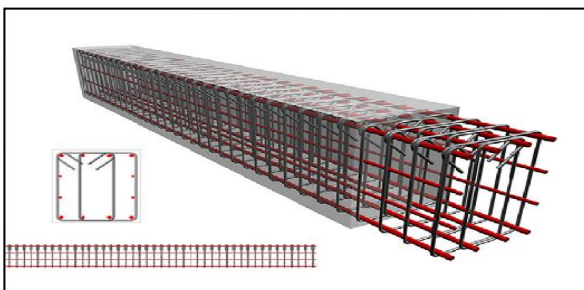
Vigas de concreto armado y perfilería de acero, fuente: Google imágenes.
